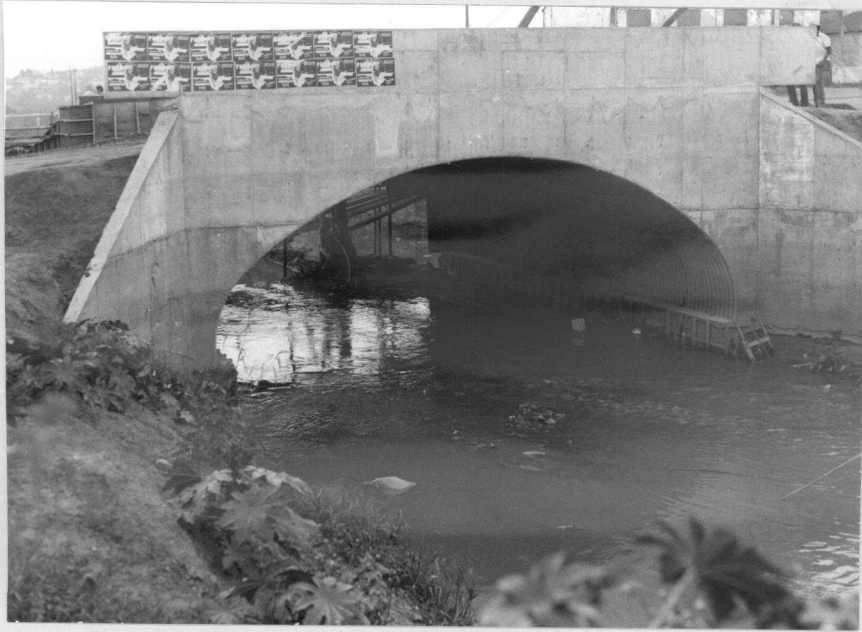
Galeria metálica em arco em substituição à ponte convencional.
